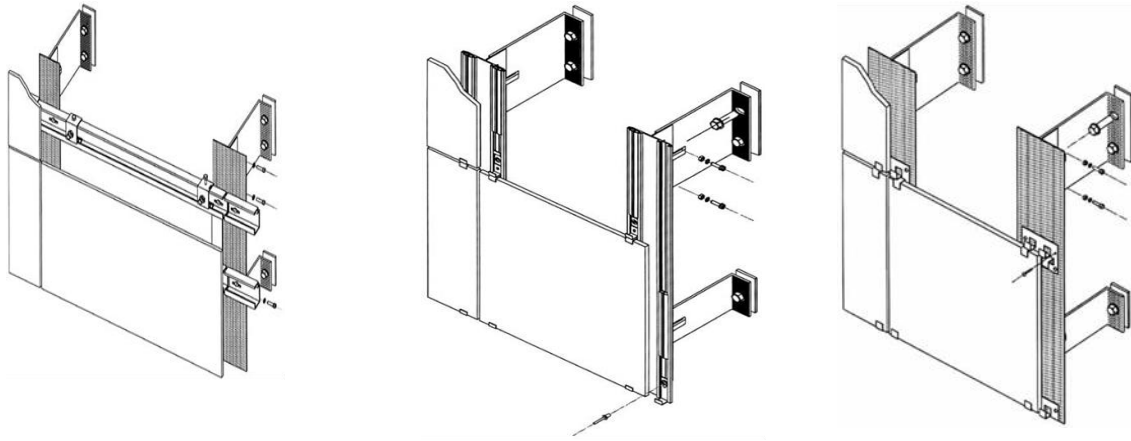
Конструктивні схеми монтажу керамогранітних плиток скрите кріплення; видимо кріпленні
